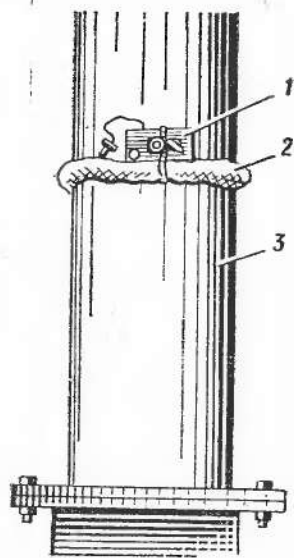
Минирование железобетонной опоры контактной сети электрифицированной железной дороги:
